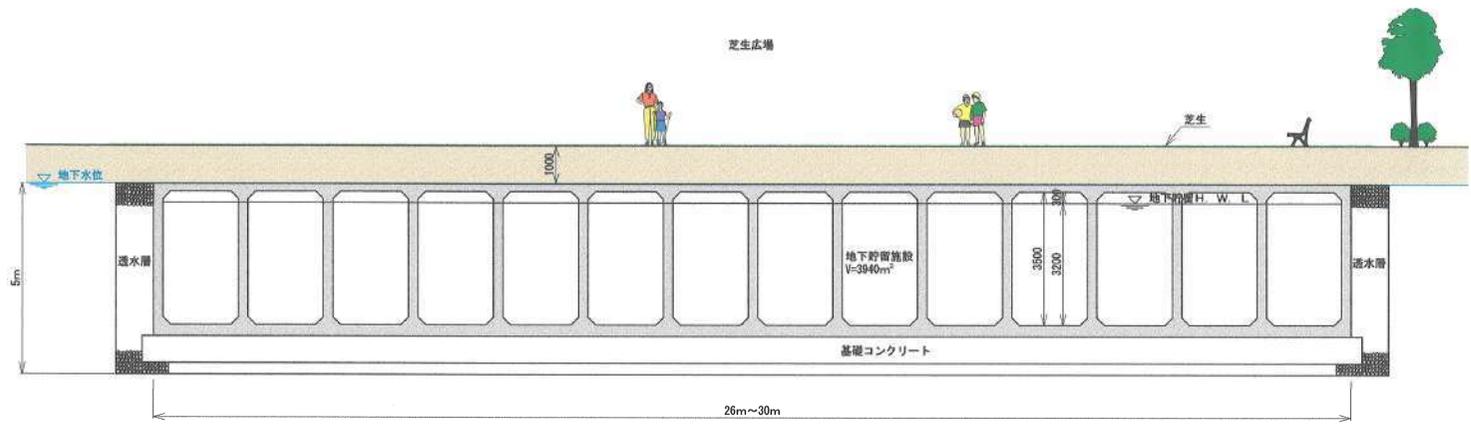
(1) 調整池 (3) 平面図 (3号公園)
